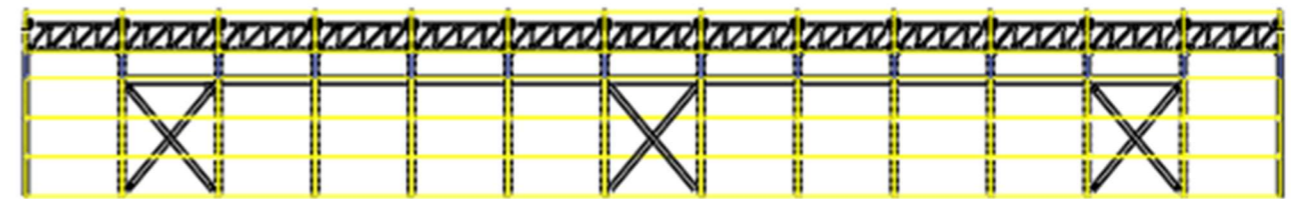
Disposición paneles de cerramiento en fachada lateral.
